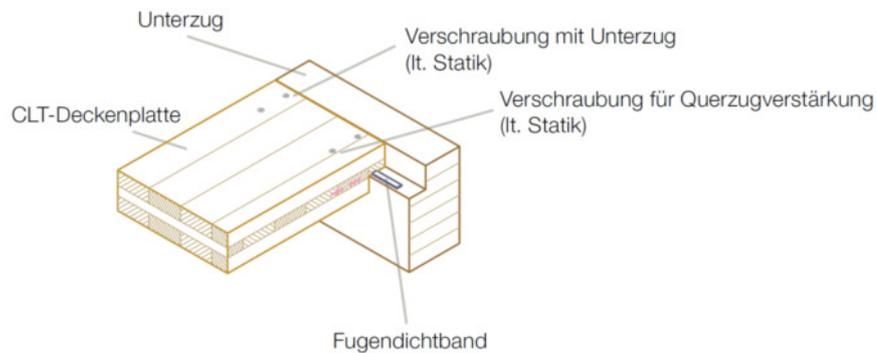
Deckenstoß mit Unterzug aus Holz mittels Stufenfalz ¹⁶⁹
